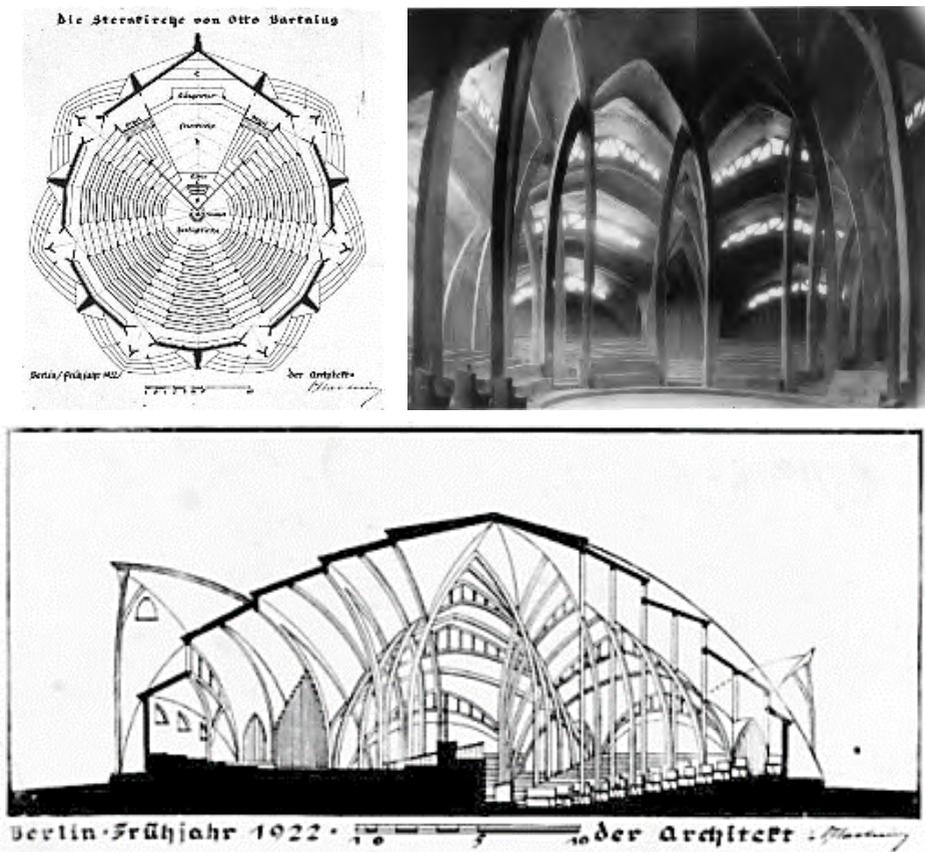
Otto Bartning, Sternkirche, 1922. Pianta, sezione e vista interna del modello in gesso
